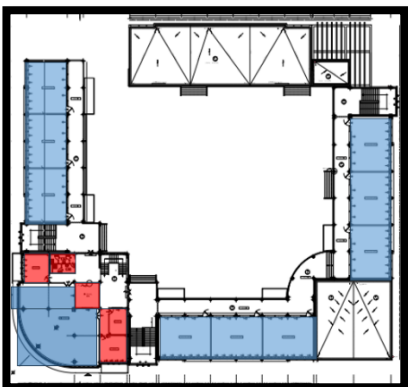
PLAN DU DEUXIEME ETAGE NIV ; +07.48 ECHELLE :1/50
